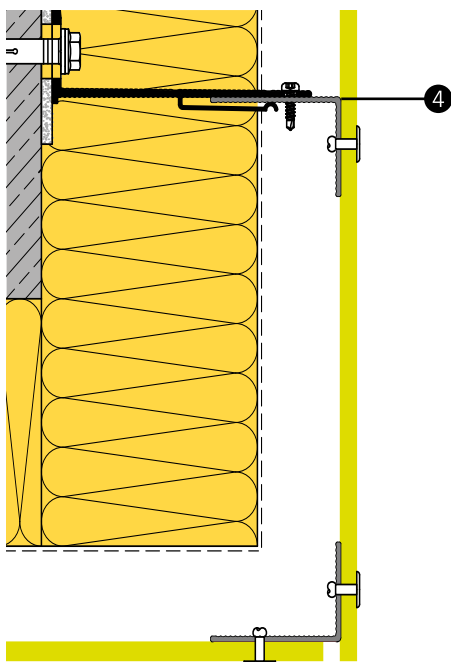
DETAILLERING: HORIZONTALE DOORSNEDES ALUMINIUM ACHTERCONSTRUCTIE GENAGELD
